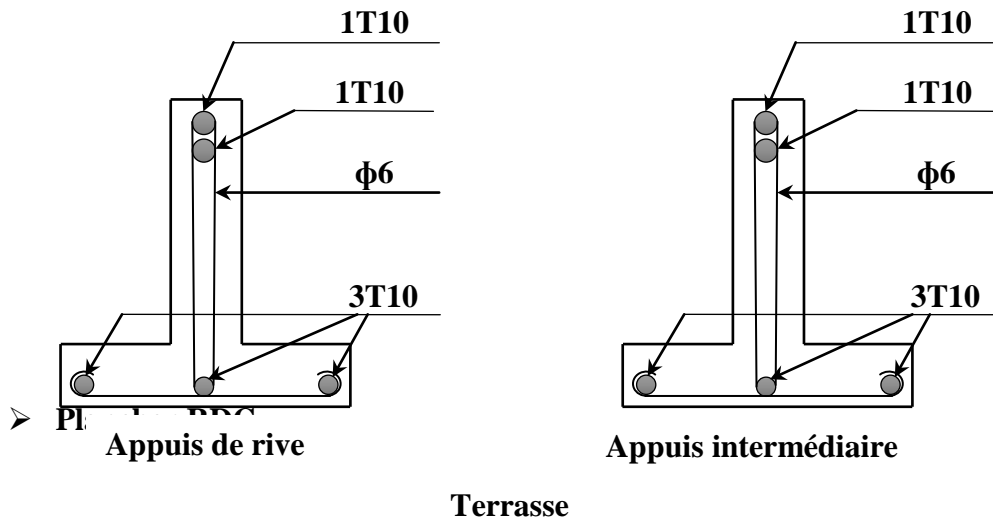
Dessin de ferrailage de poutrelle (terrasse).
